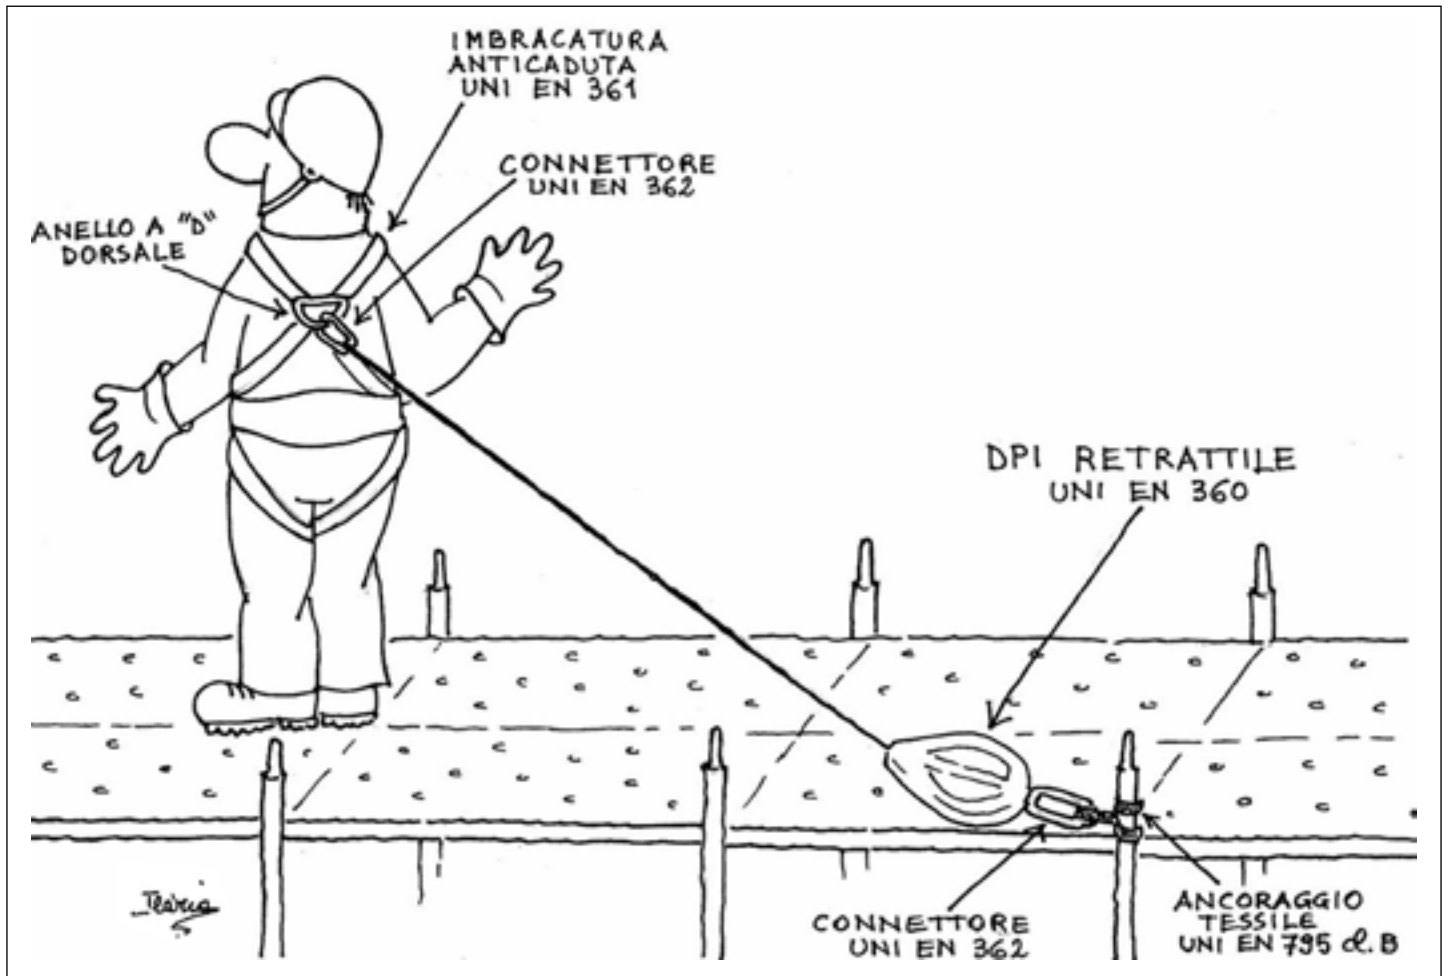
Sistema di arresto di caduta formato da un dispositivo di protezione individuale anticaduta di tipo retrattile collegato al ponteggio.
